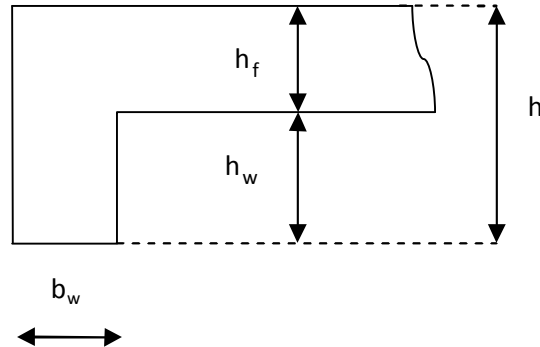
Dimensions d'une poutre coulée de manière monolithe avec une dalle.
